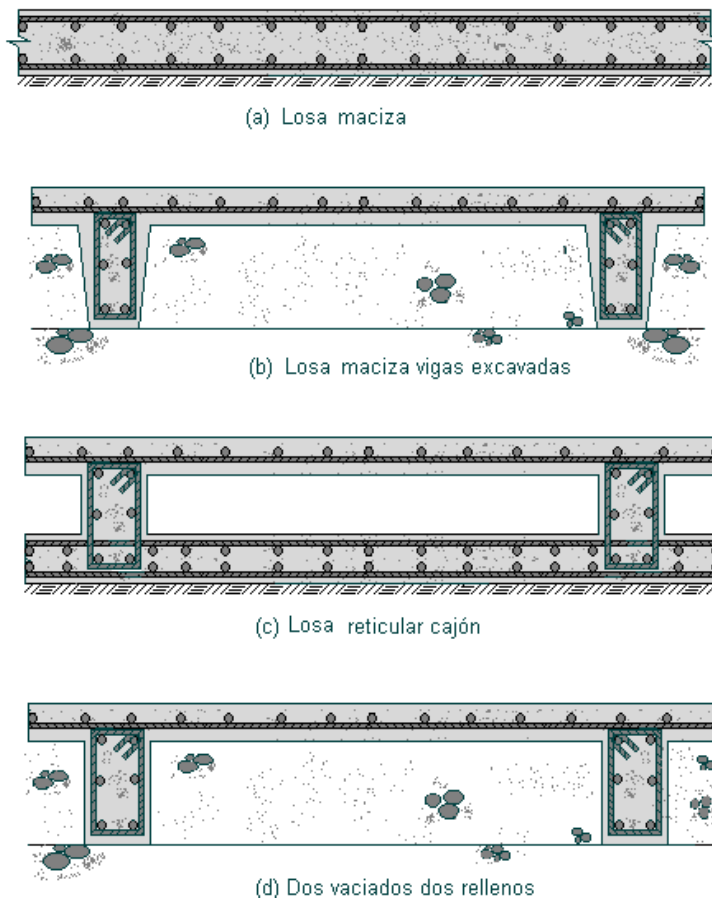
Diversas formas de diseñar y construir una losa de cimentación.
